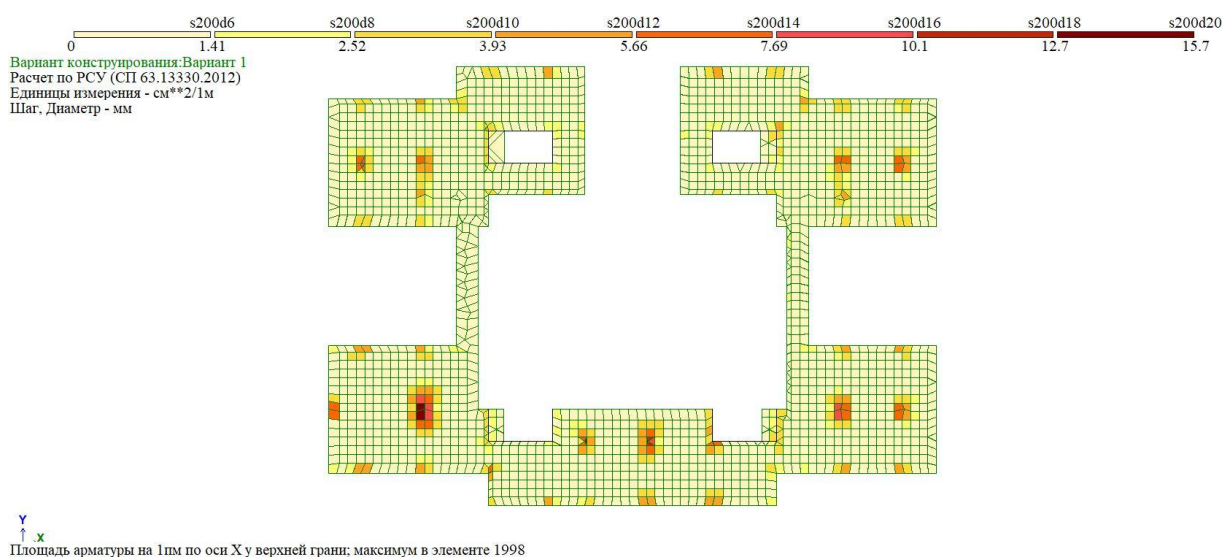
Верхняя арматура в плите перекрытия вдоль оси X
